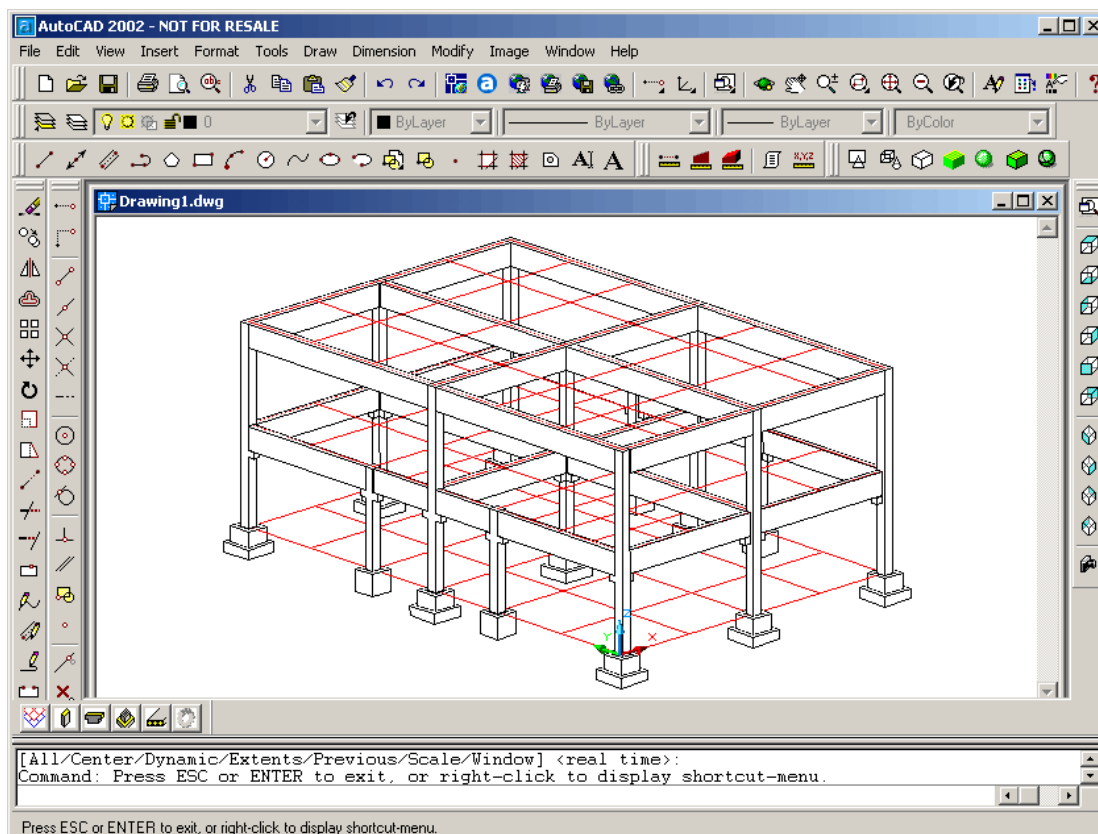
Estrutura com pilares, vigas nos pavimentos 1 e 2 e blocos de fundação.
